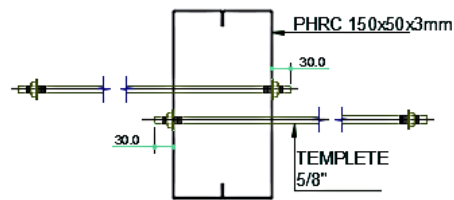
Detalle de correas para cubierta, Zona A. Fuente: Autor
